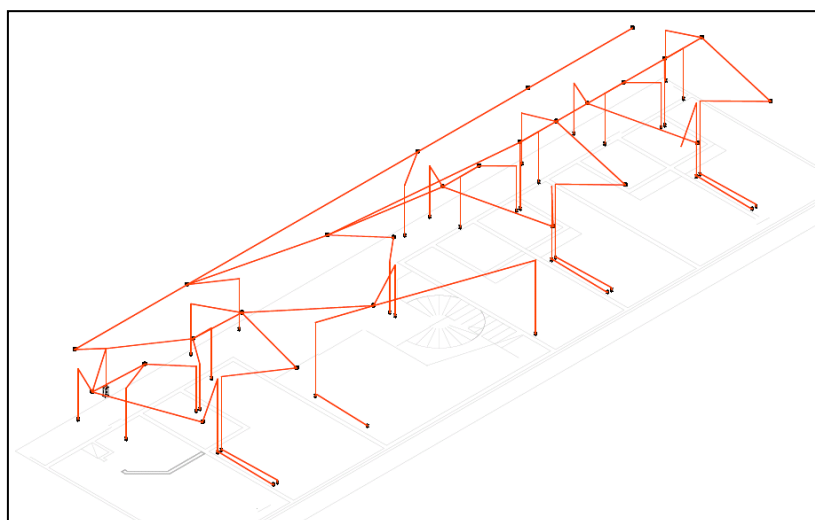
Esquema 3D da distribuição da fiação no 1º pavimento. Fonte: AUTOR (2017).
